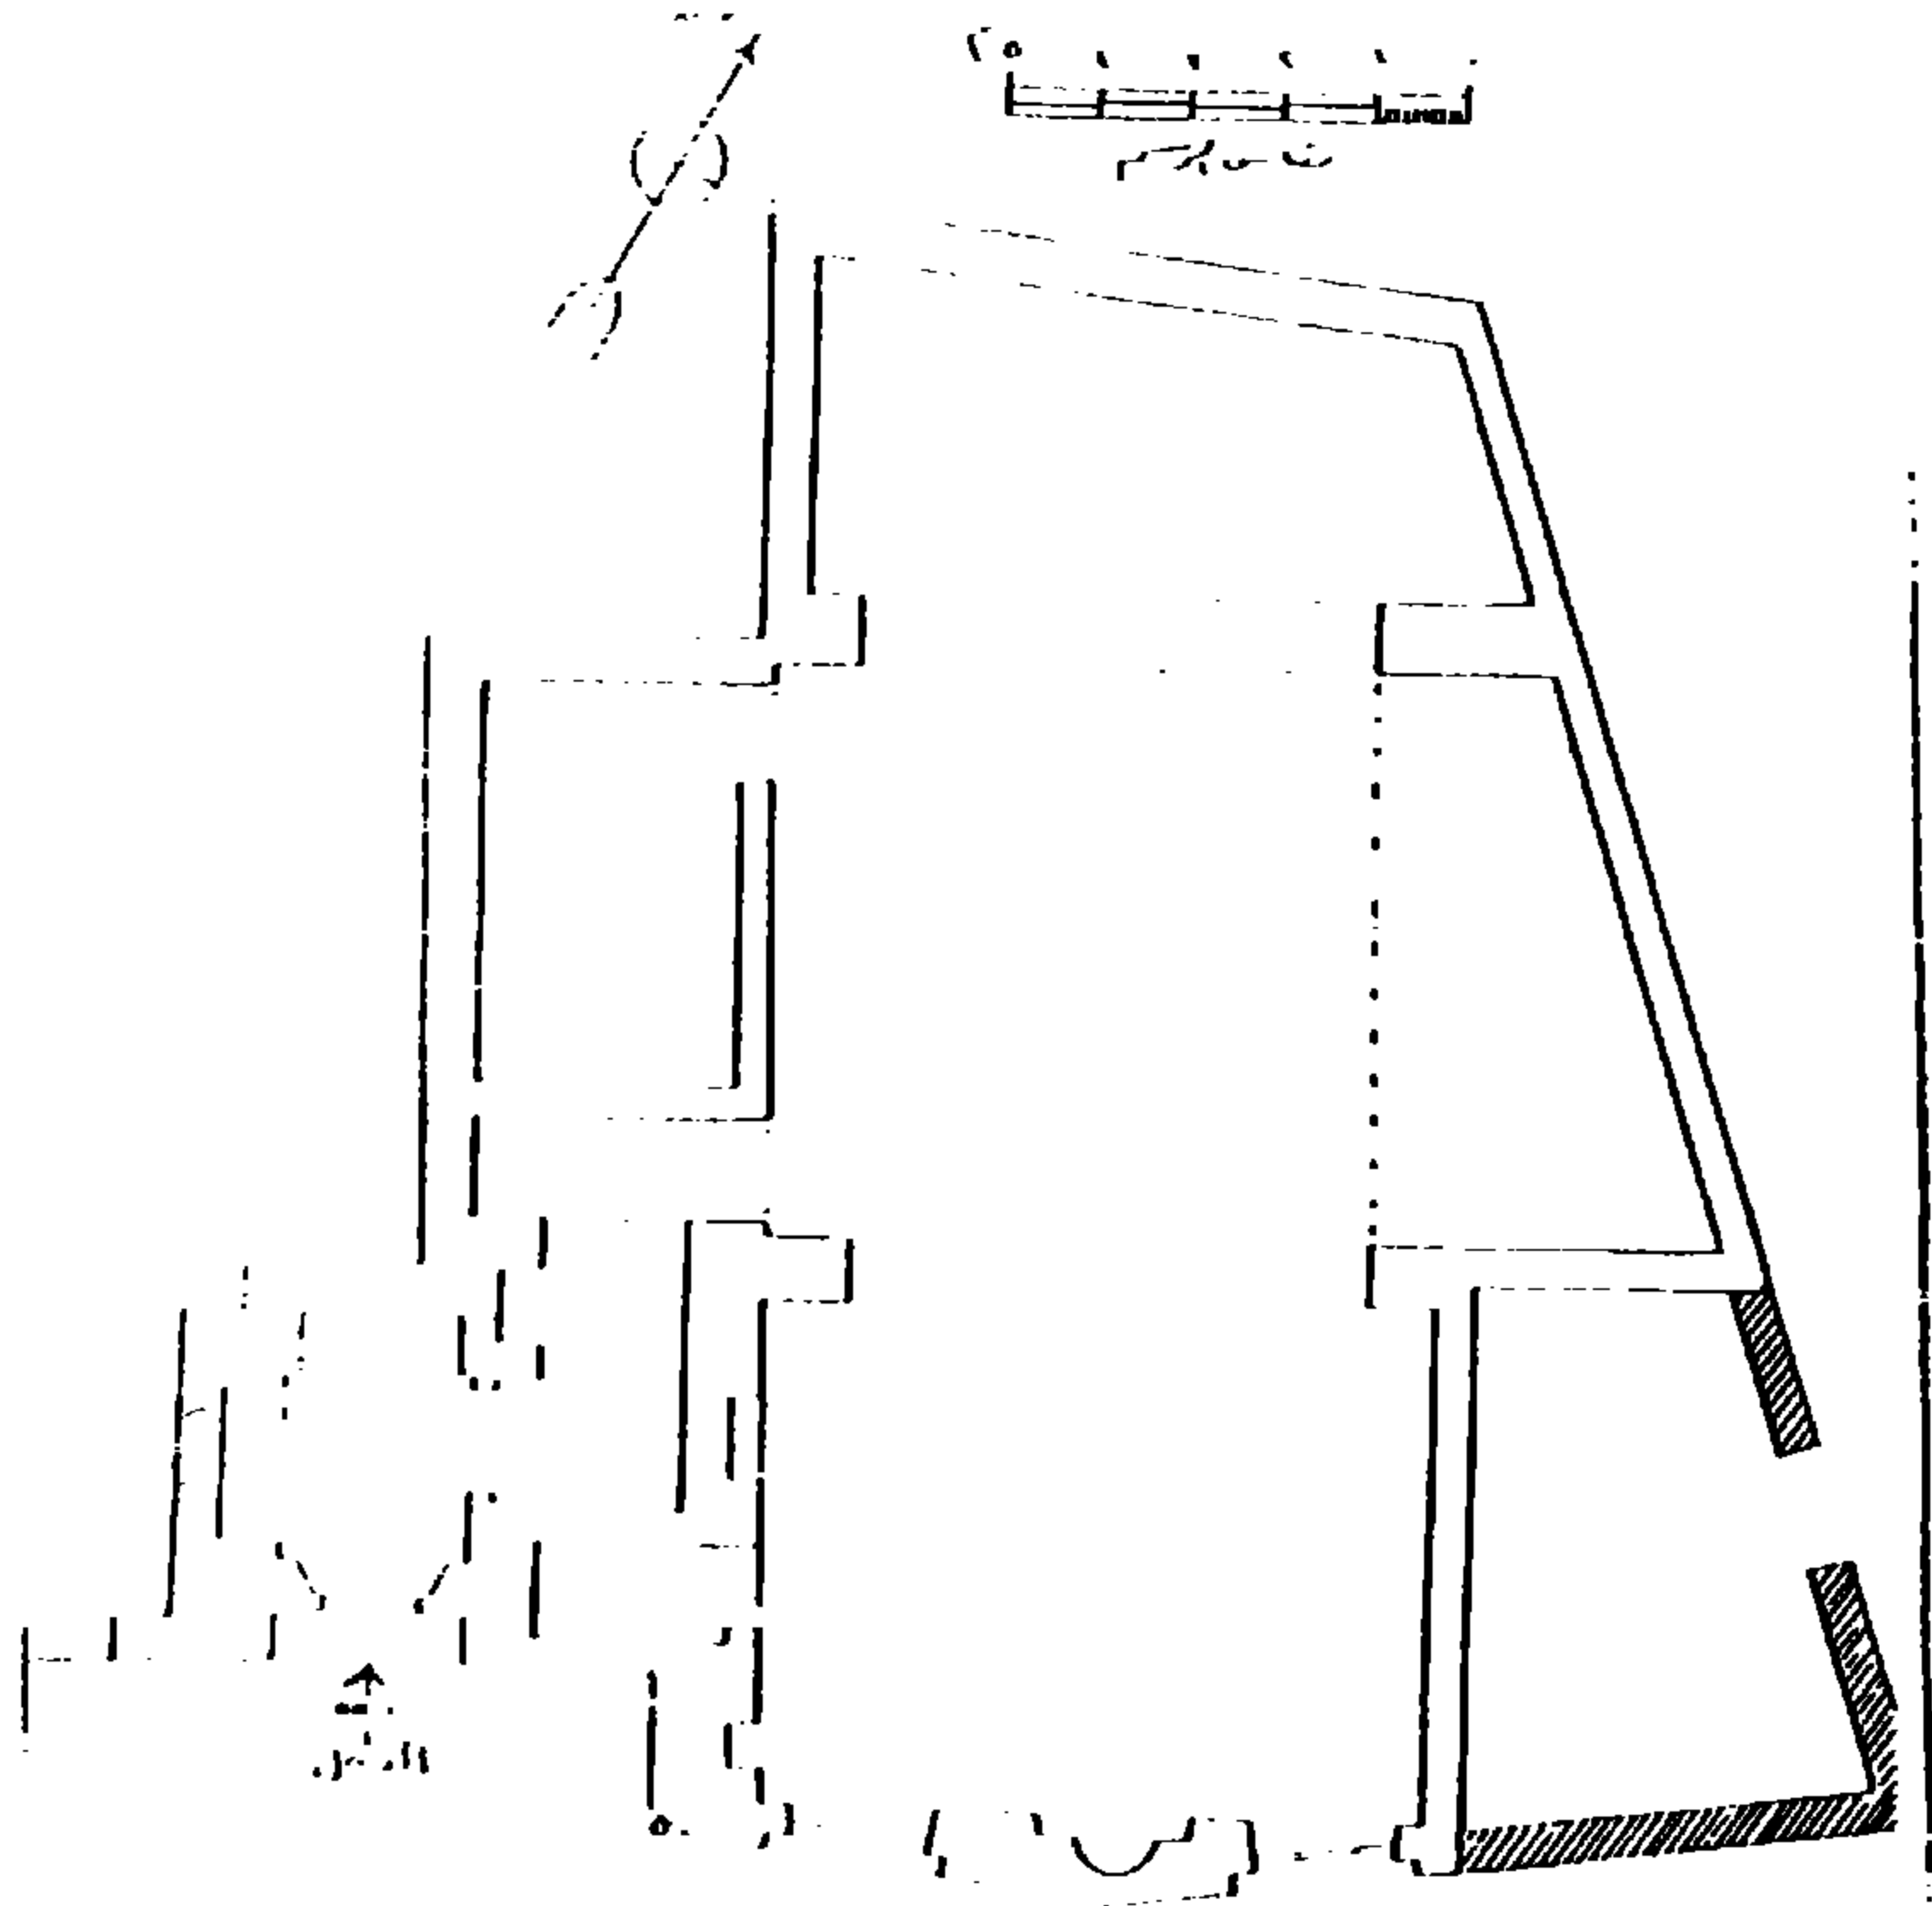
المسقط الأفقى لجامع المحمودية
